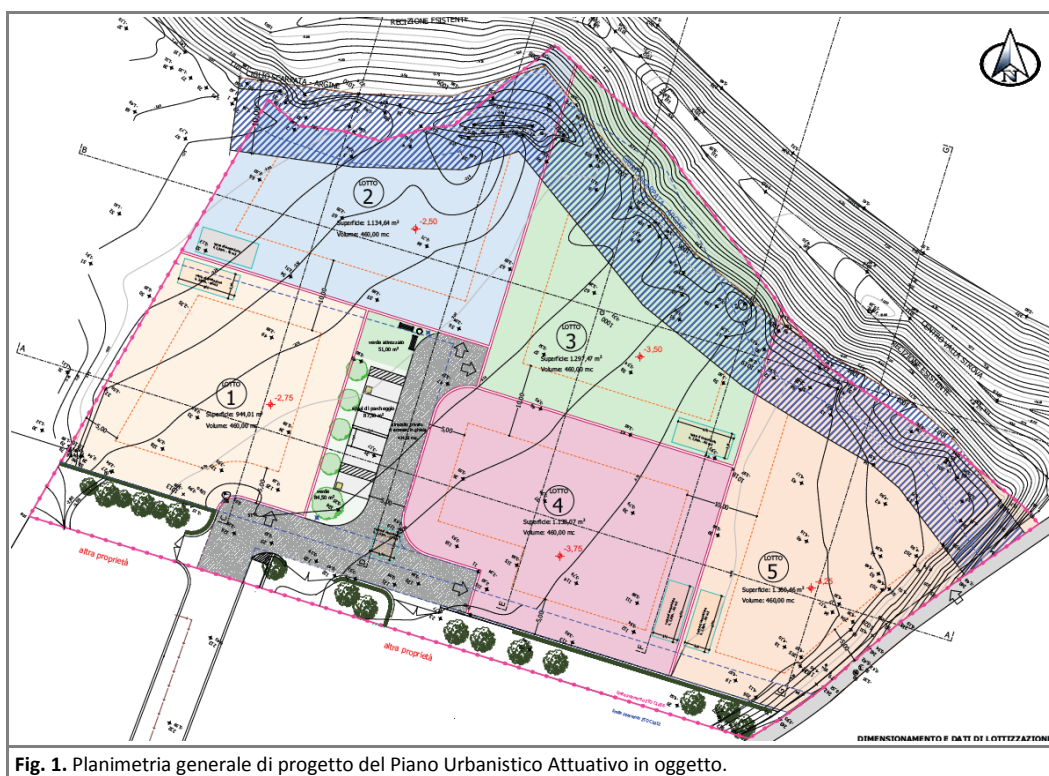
Planimetria generale di progetto del Piano Urbanistico Attuativo in oggetto.
